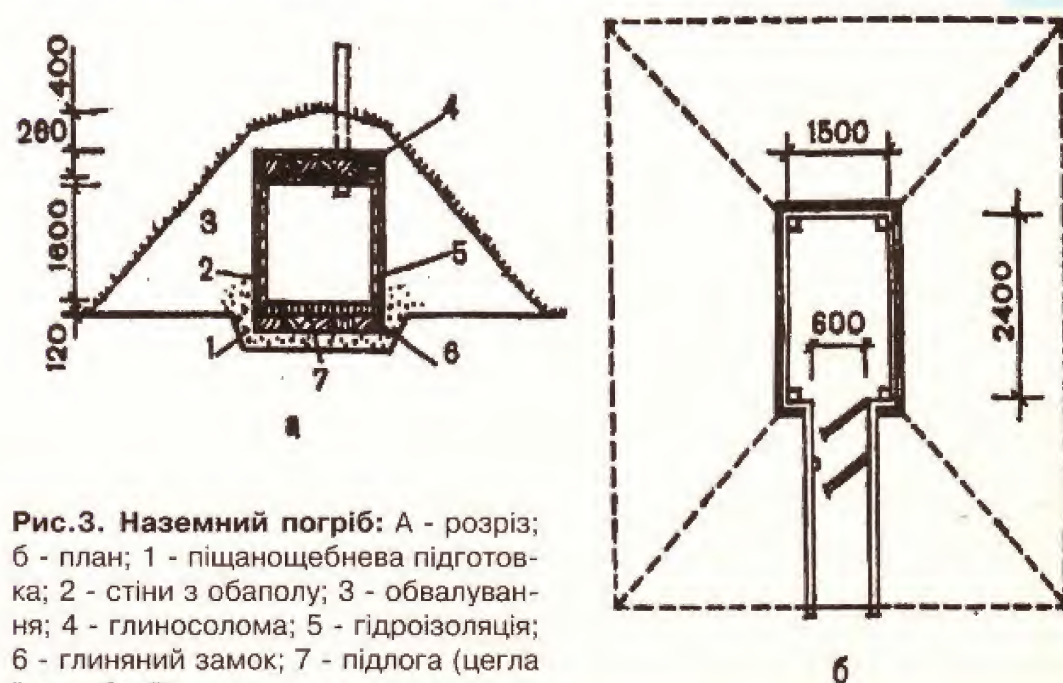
Наземний погріб: А - розріз; Б - план; 1 - піщанощебнева підготовка; 2 - стіни з обох боків; 3 - обвалування; 4 - глиносолома; 5 - гідроізоляція; 6 - глиняний замок; 7 - підлога (цегла "на ребро").
